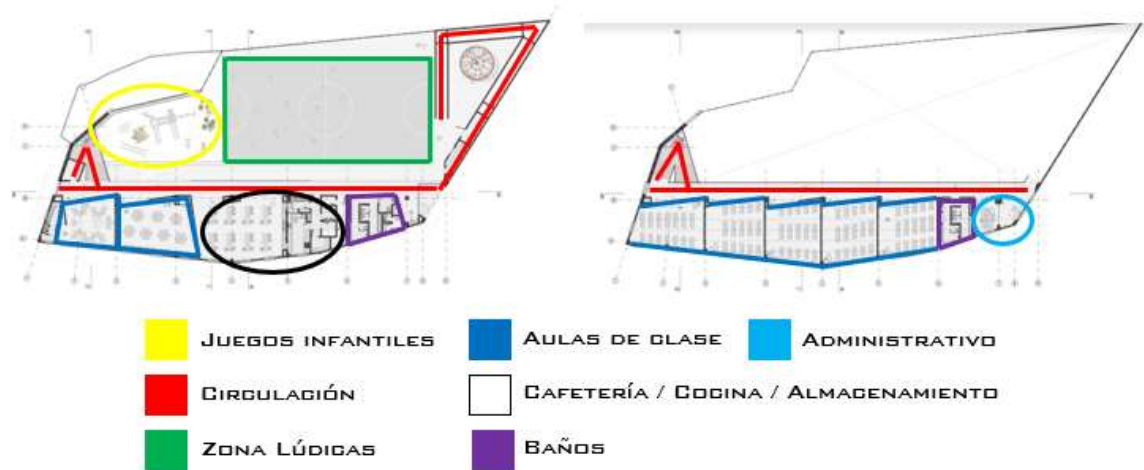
Planos instituto rural chaparral. Adaptada de Archdaily.
